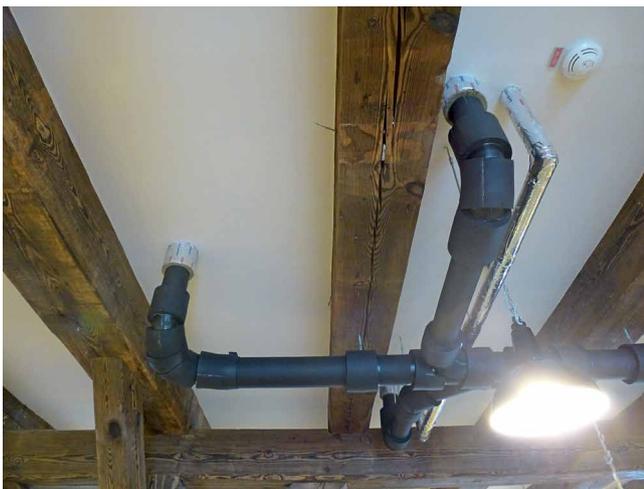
Abschottung in einer bestehenden Holzbalkendecke
